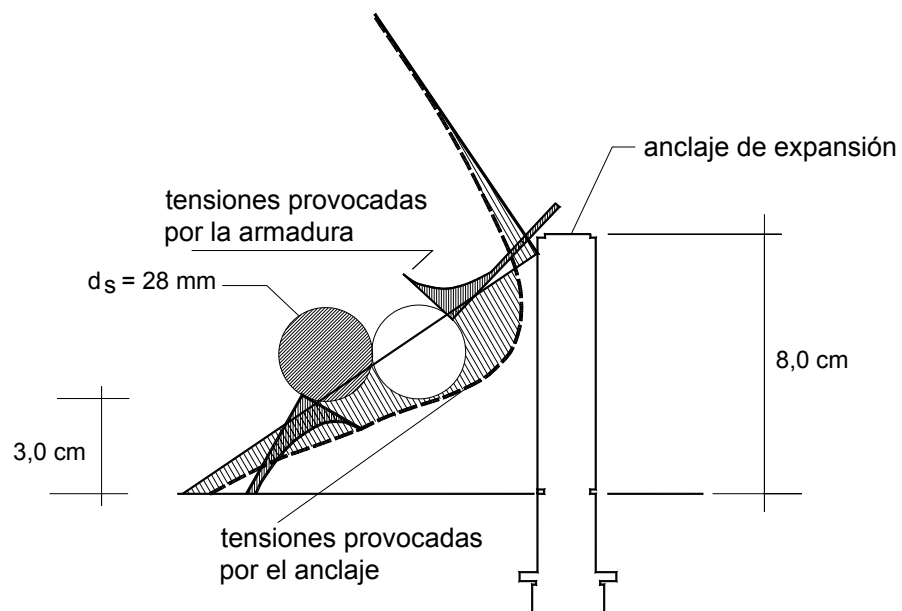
Anclaje en la región de un empalme por yuxtaposición (corte transversal). Superposición de las tensiones provocadas por las barras y por el anclaje (Eligehausen, 1984)
